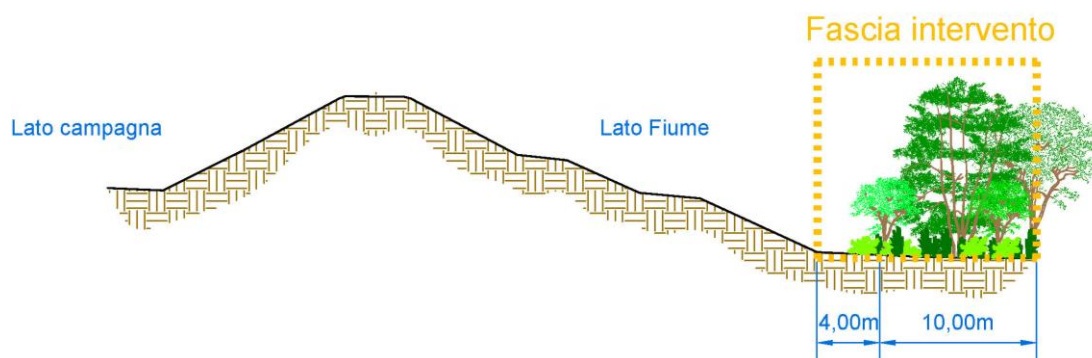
Località San Damaso stradello Cave Rubbiani (MO) - Sezione Tipo stato di fatto
